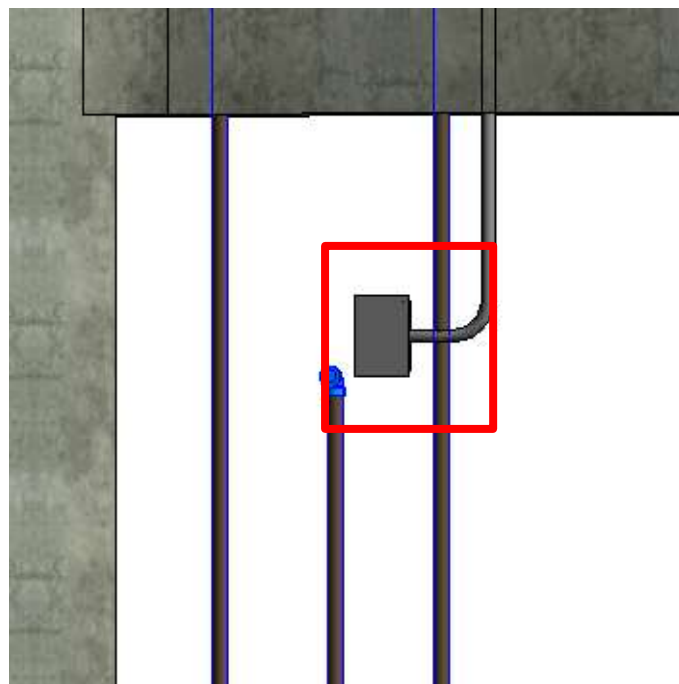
Sobreposição do conduíte na tubulação hidráulica e pilar.
